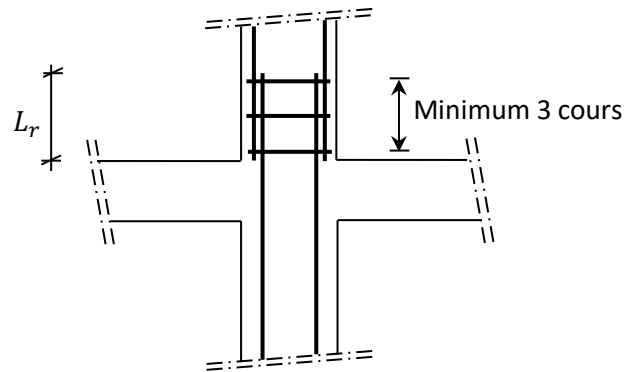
Les armatures transversales dans la zone de recouvrement
